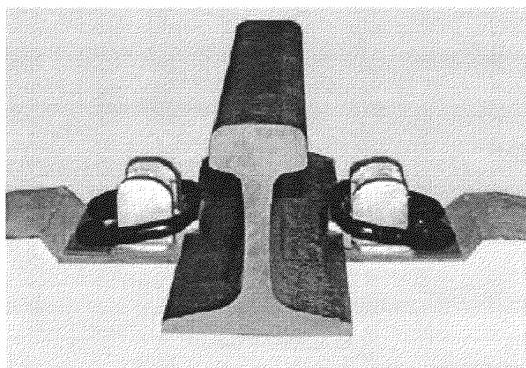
Упругое нераздельное рельсовое скрепление с прутковыми торсионными клеммами для железобетонных шпал (подкладка и клеммы закреплены к шпале с помощью анкерных болтов)
